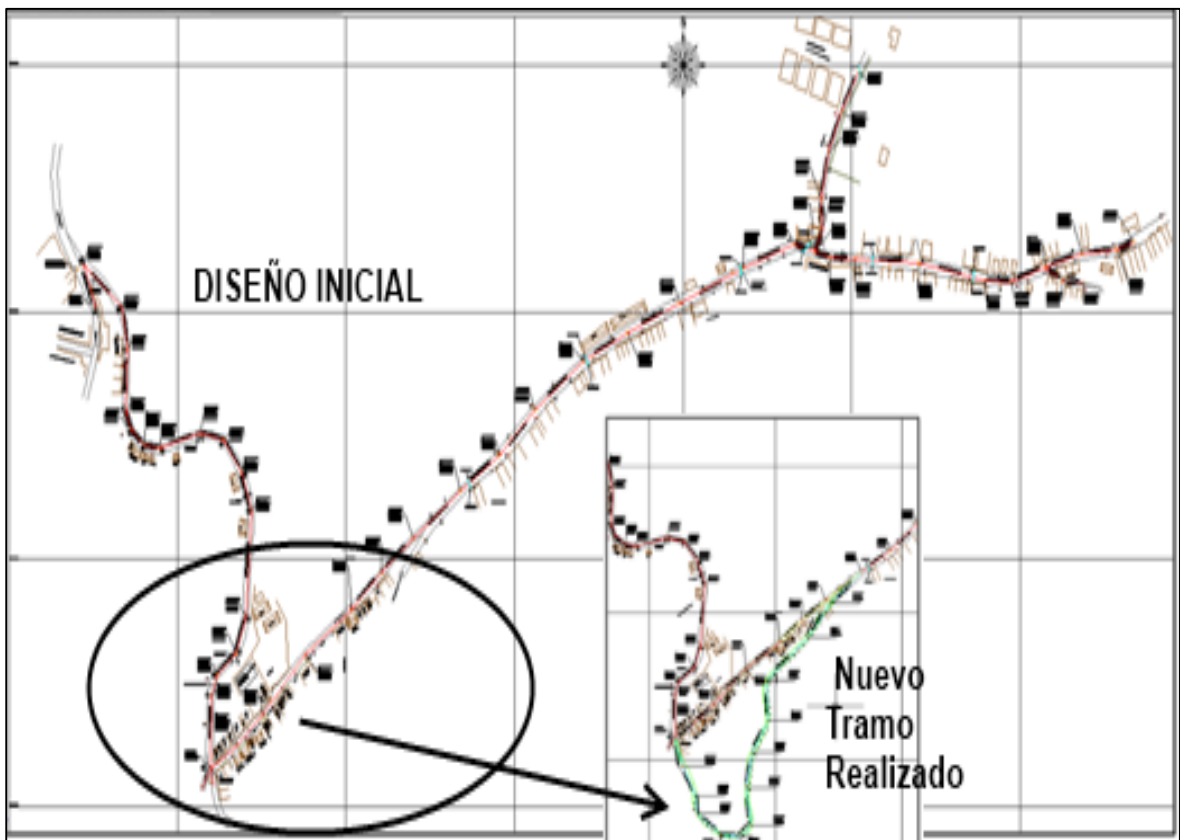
Alcantarillado para Cujacal Centro y Cujacal Bajo
